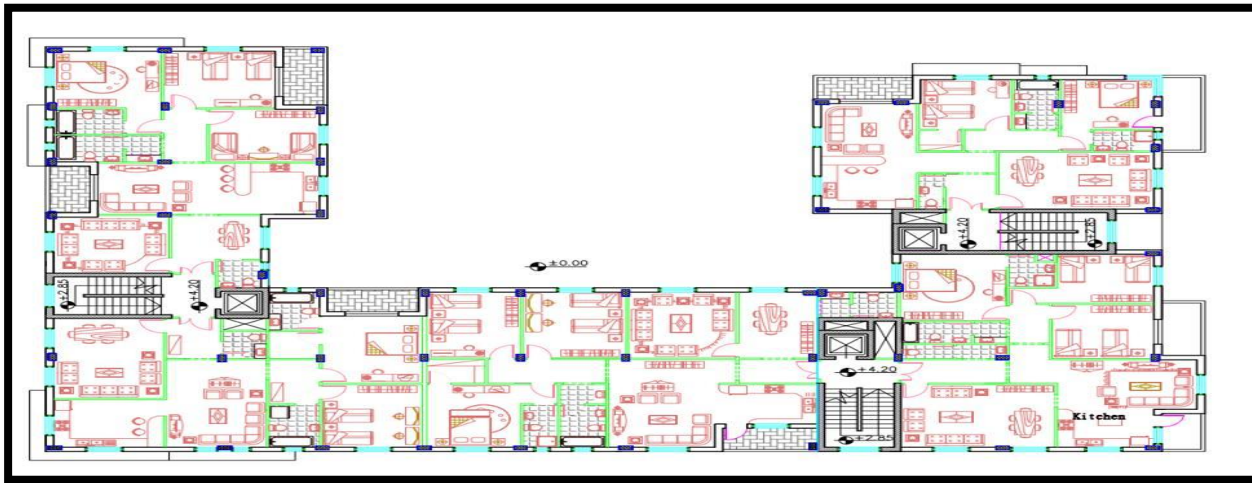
المسقط الأفقي للطابق الارضي.
